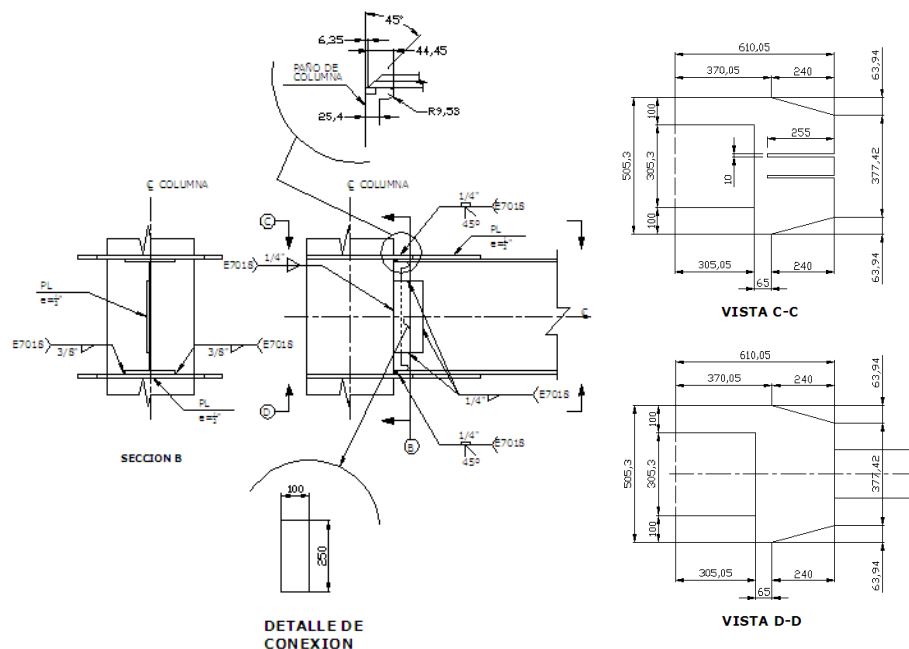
Especimen ECS2 de conexión soldada con diafragma
